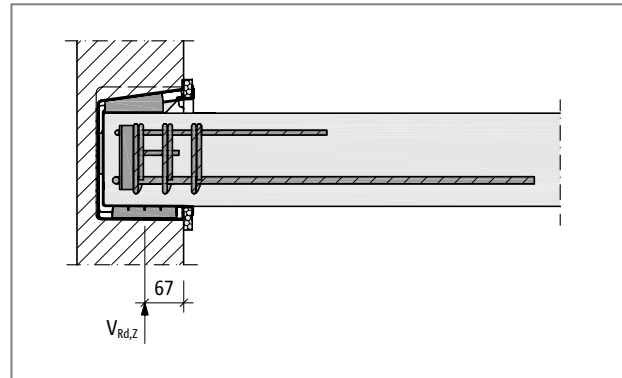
Schöck Tronsole® tipo Z, raffigurazione della linea d'azione della forza di appoggio nella parete
